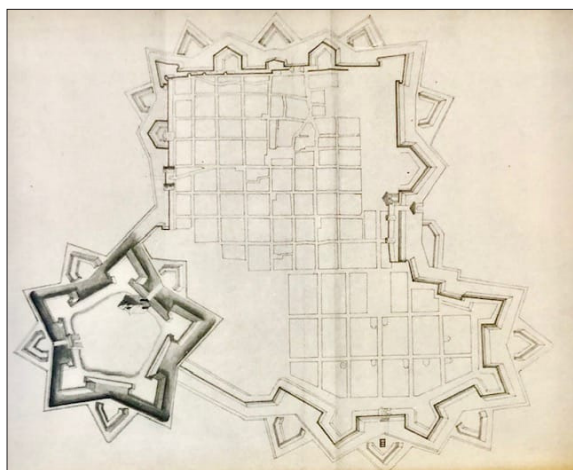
Il primo ampliamento barocco su progetto dell'architetto di corte Carlo di Castellamonte
